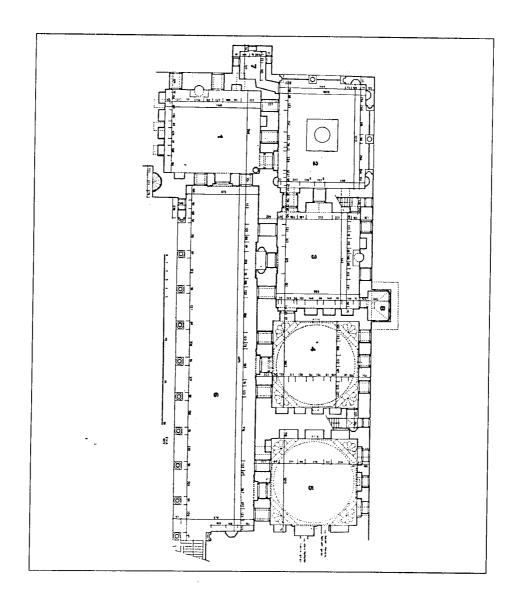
مسقط أفقي لطوب قابي سراى بإستانبول (عن : افيابان) .
